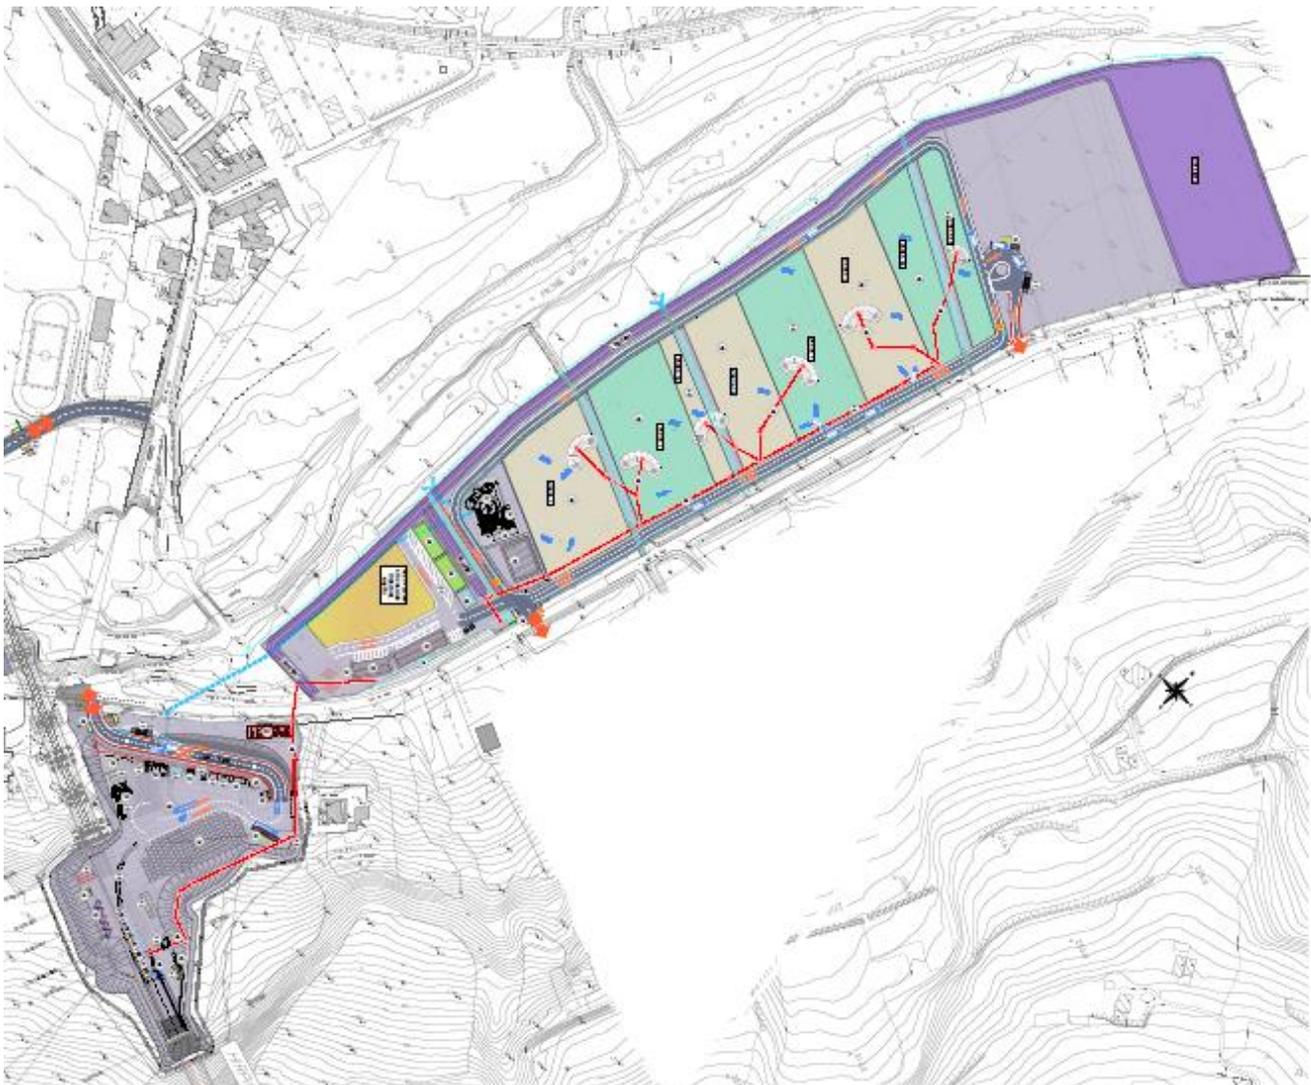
Area Rocchetta: lay-out cantiere CG-GN03.1 e aree di stoccaggio e tecniche a servizio dello scavo della galleria
